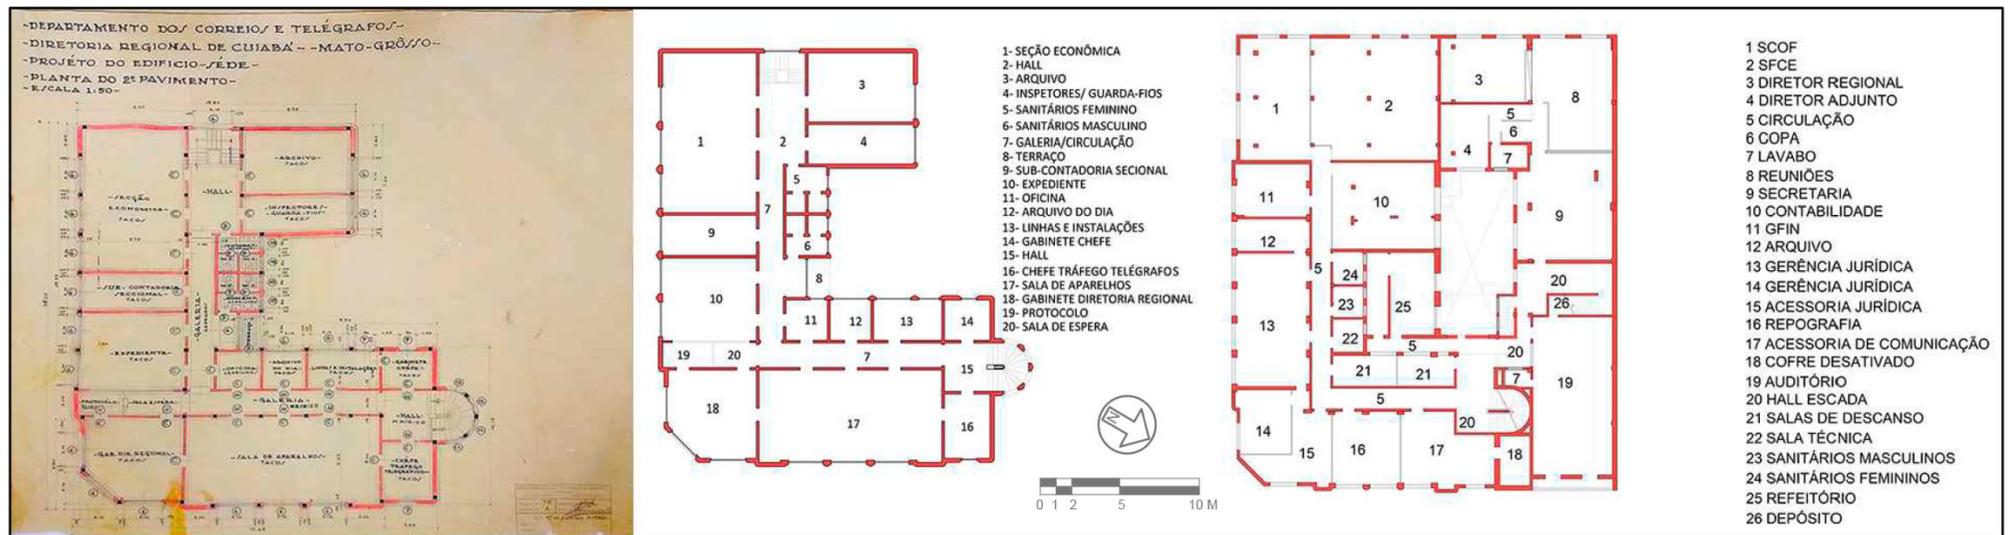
Comparativo entre as plantas do 2º pavimento do projeto original e depois das ampliações.
